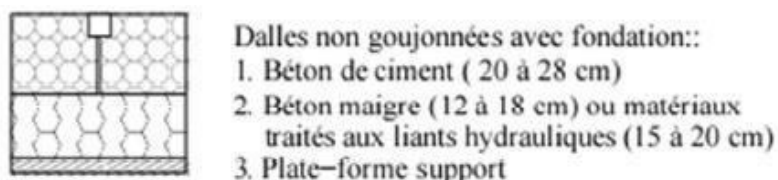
Représentation d'une chaussée en béton de ciment [5]
